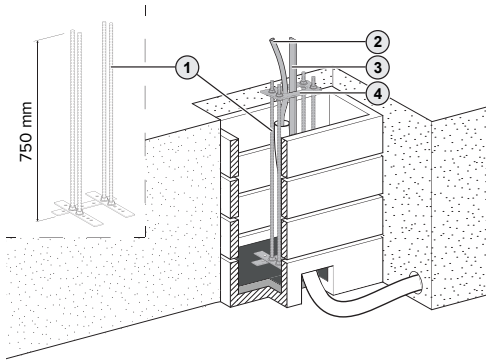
Inserire il set di montaggio per fondazione insieme alla piastra di fondazione (esempio: AMEDIO®)
